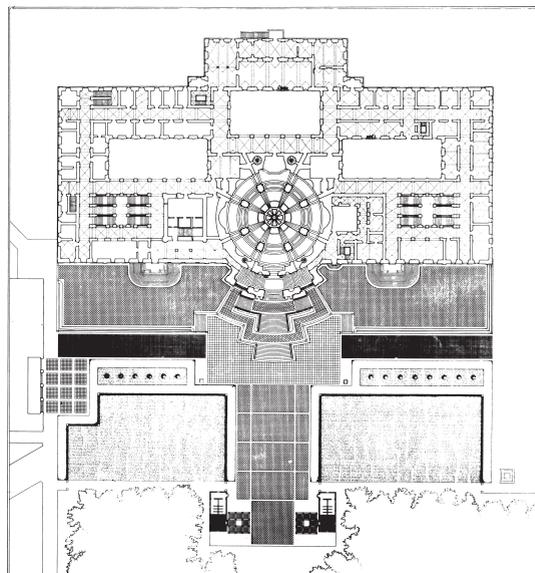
Detalle de ordenación con las lonjas construidas. Primer proyecto (1982).
